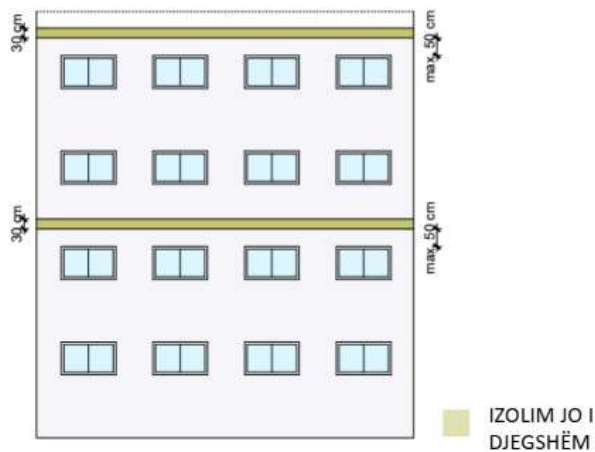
Parandalimi i përhapjes vertikale të zjarrit duke bërë një pengesë vertikale kundër zjarrit përgjatë kryqëzimit të konstruksionit të dyshemesë së secilit kat dhe murit të jashtëm [17].
